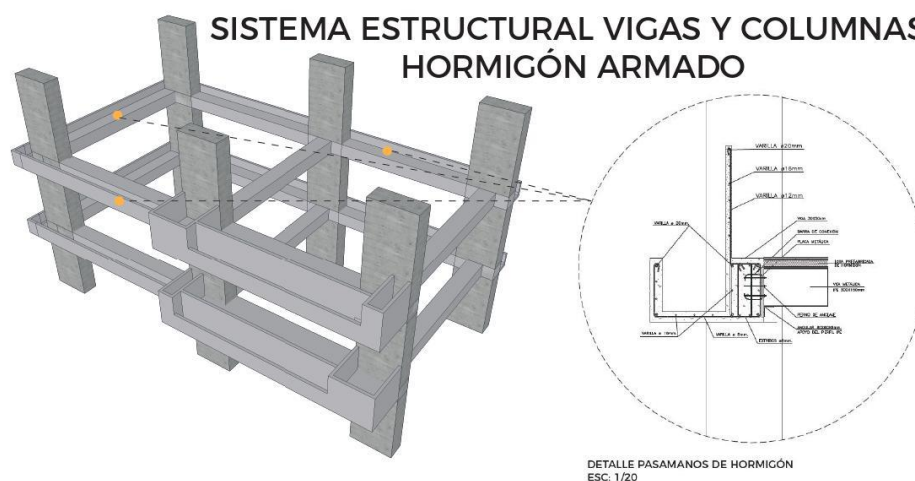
Sistema Estructural Vigas y Columnas Hormigón Armado
